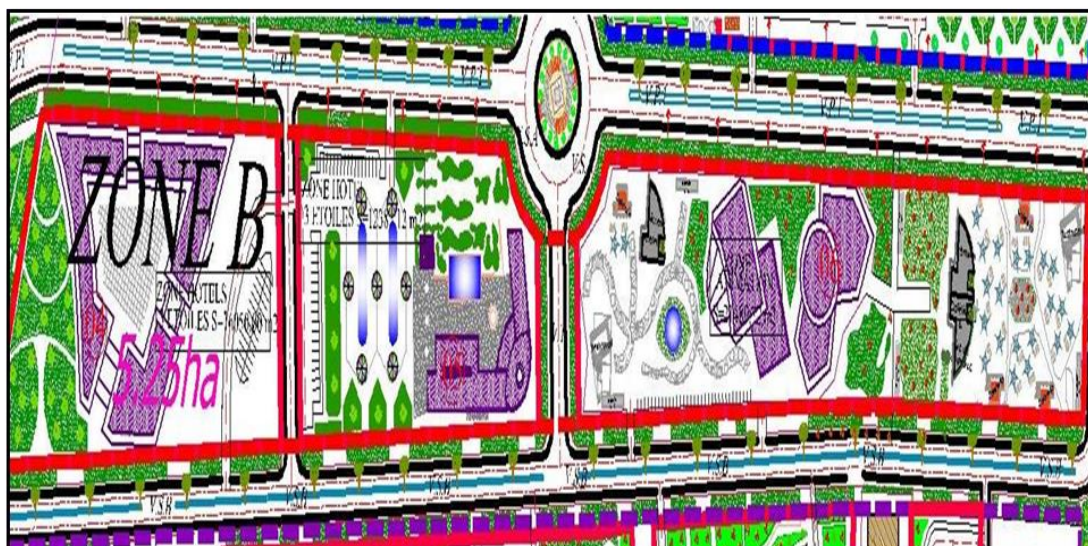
Le plan d'aménagement de la zone B dans la ZET de BENI BELAID
